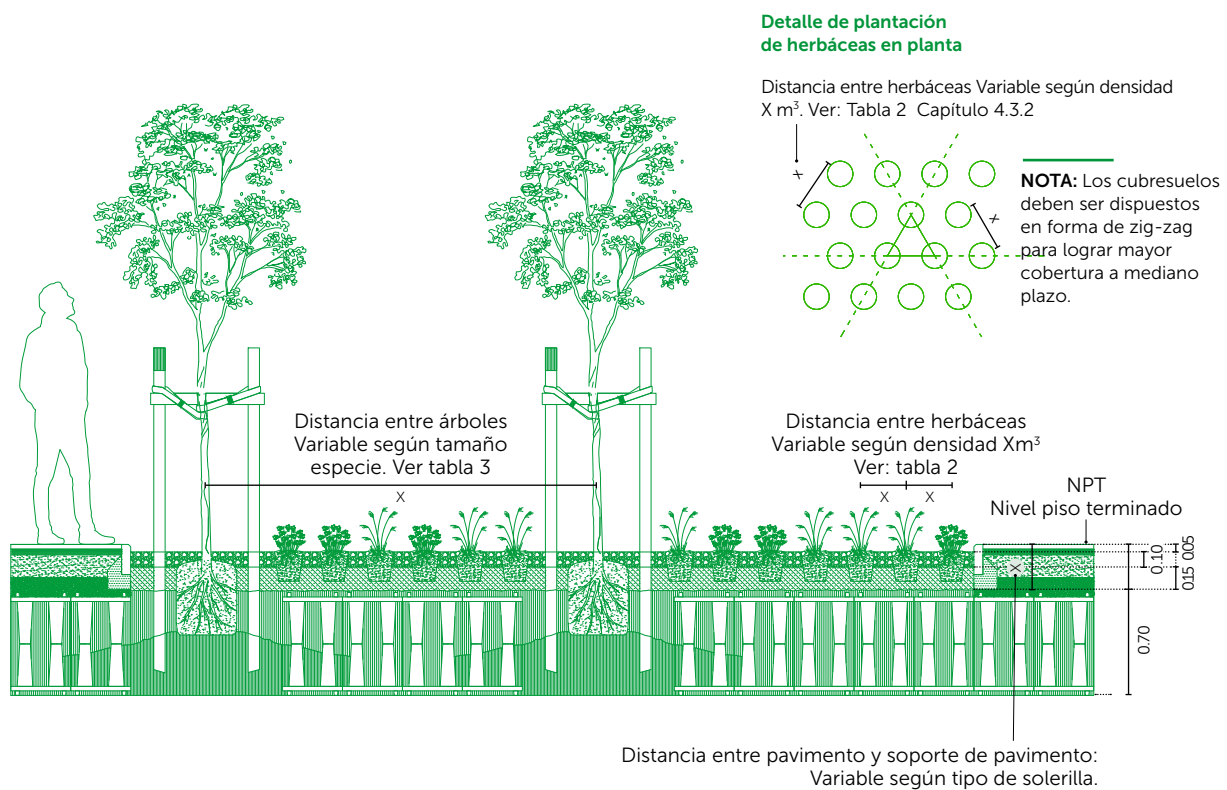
Plantación con cubo de drenaje en platanda. Fuente: Elaboración propia
